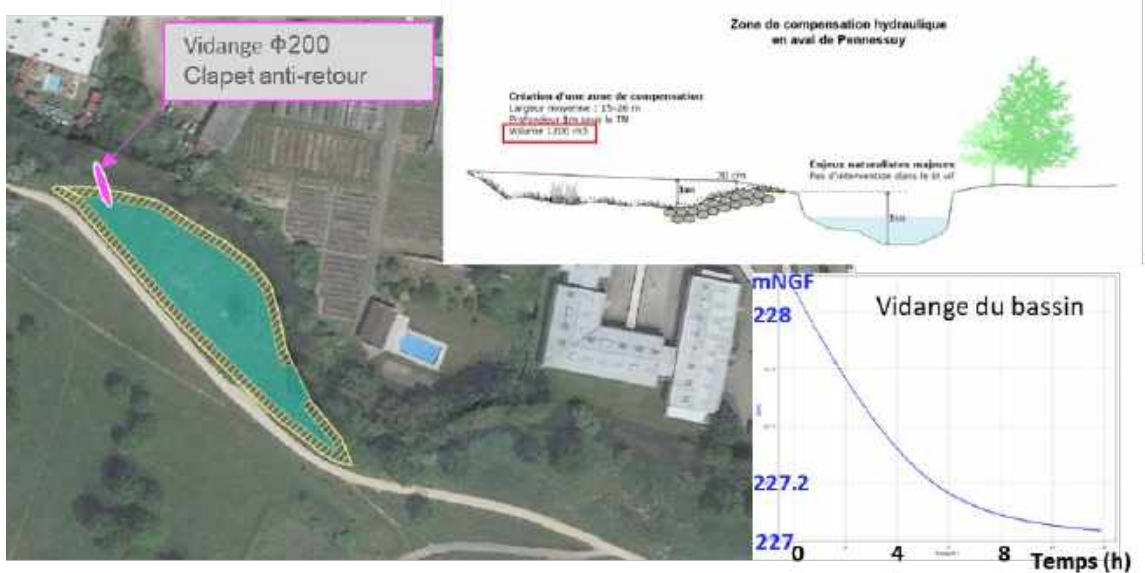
Plan d'implantation et coupe-type bassin de compensation
